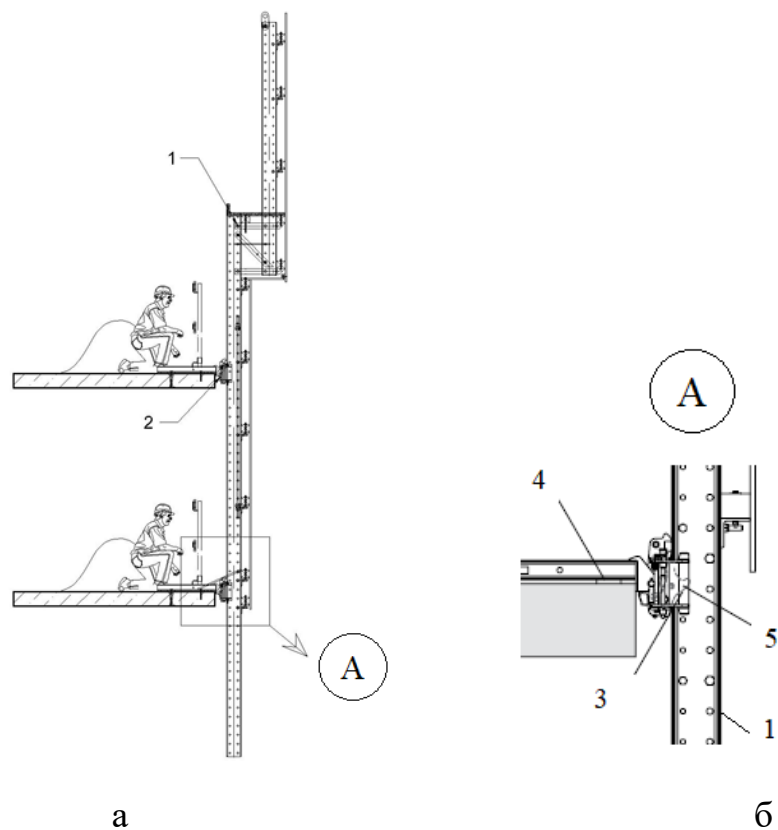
Фіксація штанги переставної в башмаку на нижньому поверсі; а – загальний вид; б – вузол «А», де: 1 – захисна панель; 2 – башмак перекриття верхньої плити; 3 – замок башмака; 4 – башмак перекриття нижньої плити; 5 – опорний гачок
